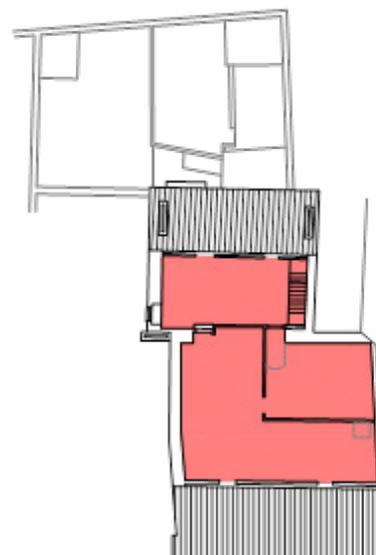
Planta do caso 1, 1994. Planta do sótão do fogo 1º direito.
